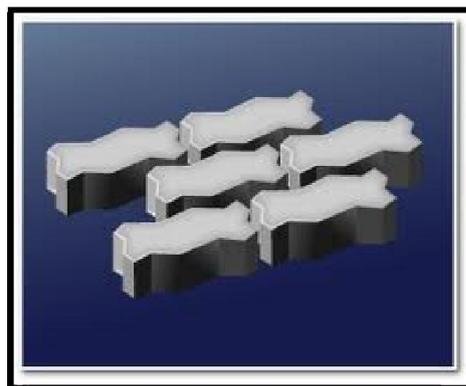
Adoquín de pavimento articulado. Fuente: Google, Imágenes.
